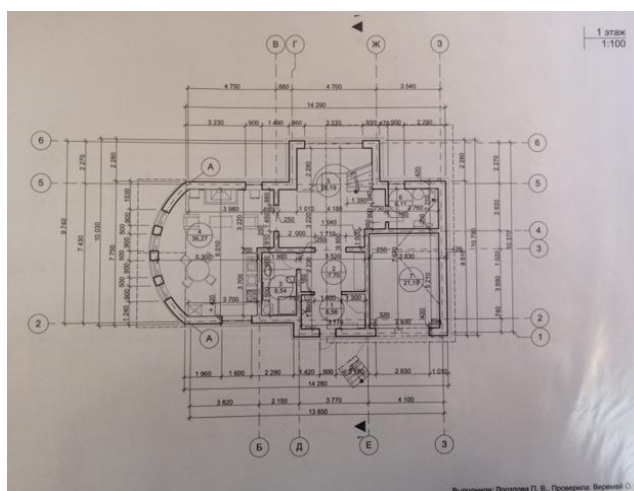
Работа 1. Один из выполненных планов здания (план первого этажа)
